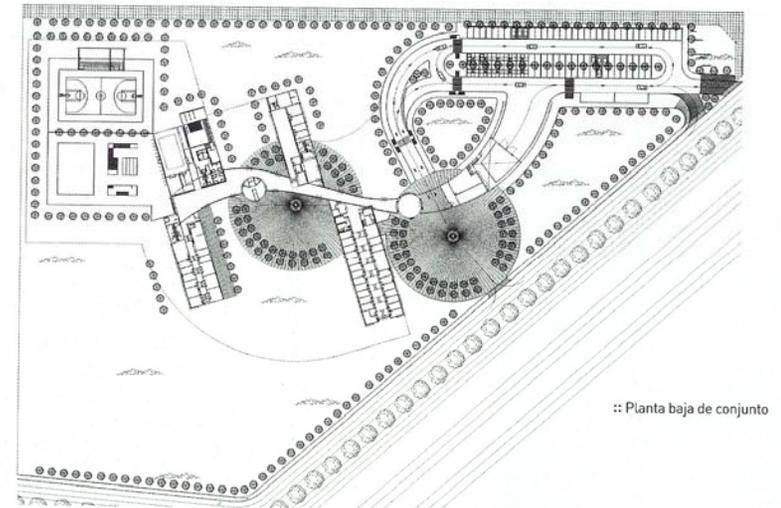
Distribución Planta Baja CRIT Guanajuato
